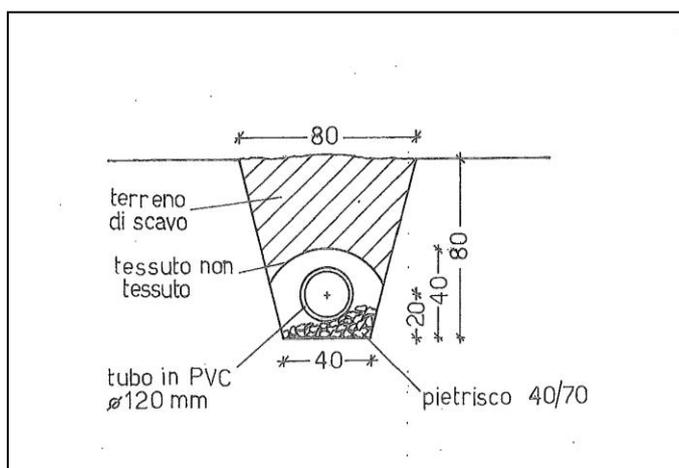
SEZIONE CONDATTA DISPERDENTE
